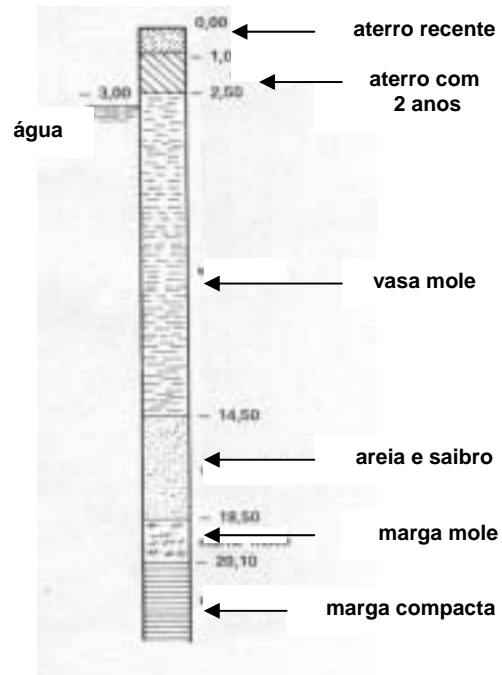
Corte do terreno no qual estava fundado o pavilhão desportivo
